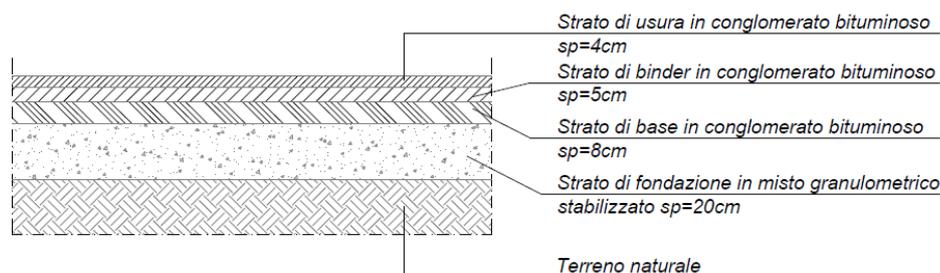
Pacchetto pavimentazione stradale asse A e asse B
